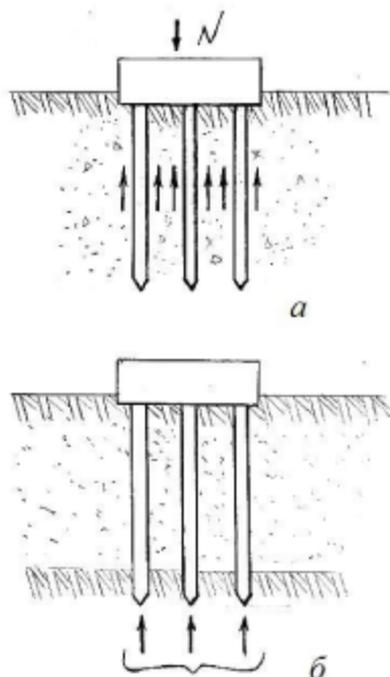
Сваи, отличающиеся по способу передачи нагрузки на грунт:
